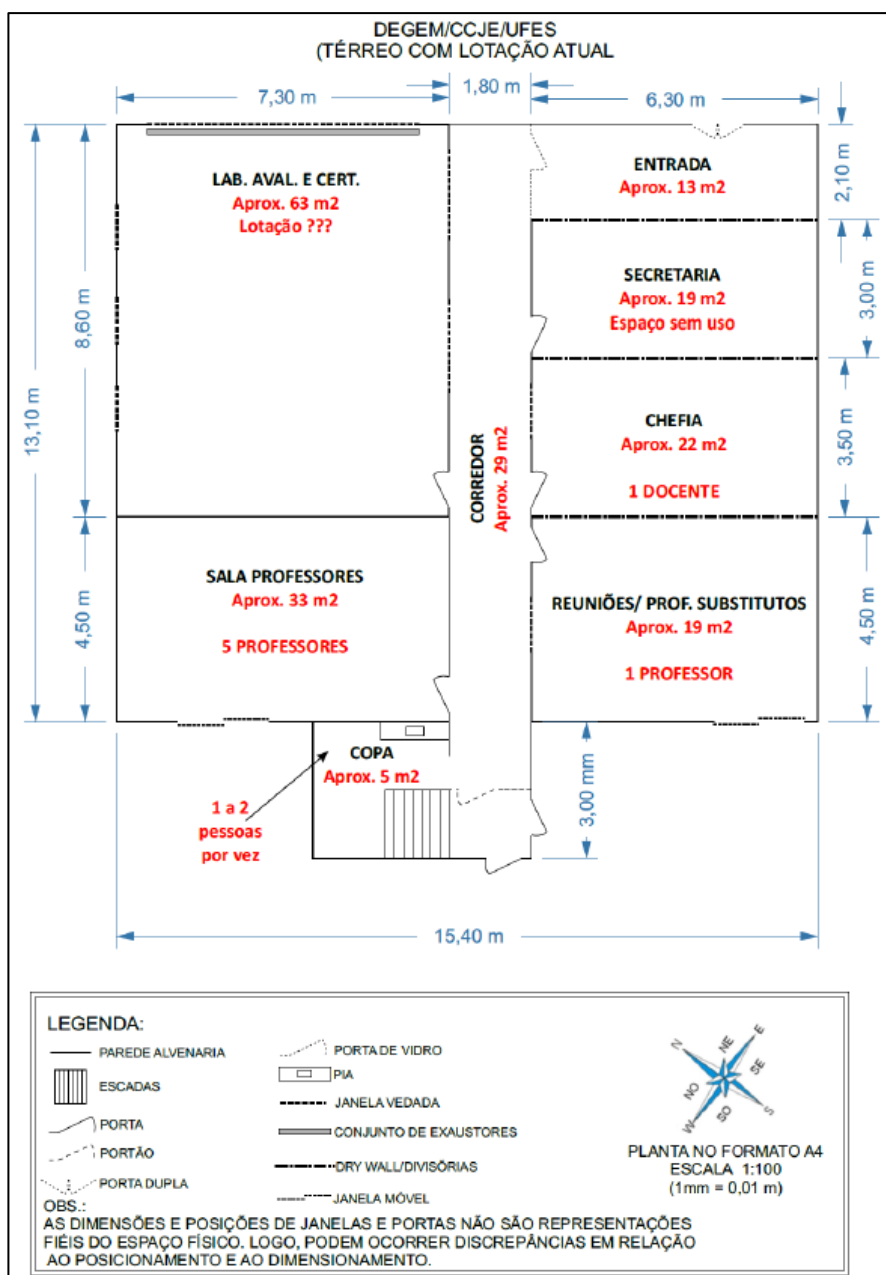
Croqui da planta térrea do Prédio da Gemologia
